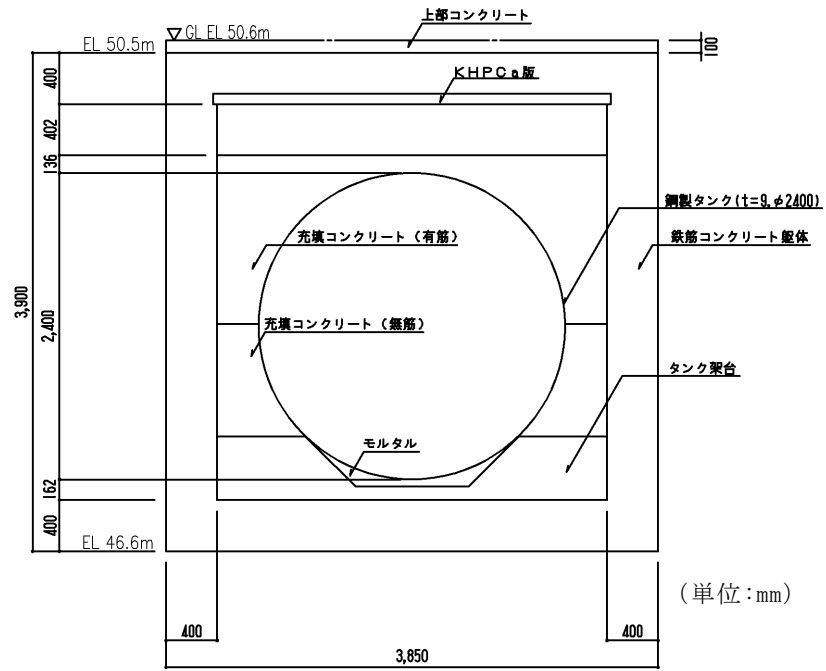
緊急時対策所用燃料地下タンク 断面図 (A-A 断面)
